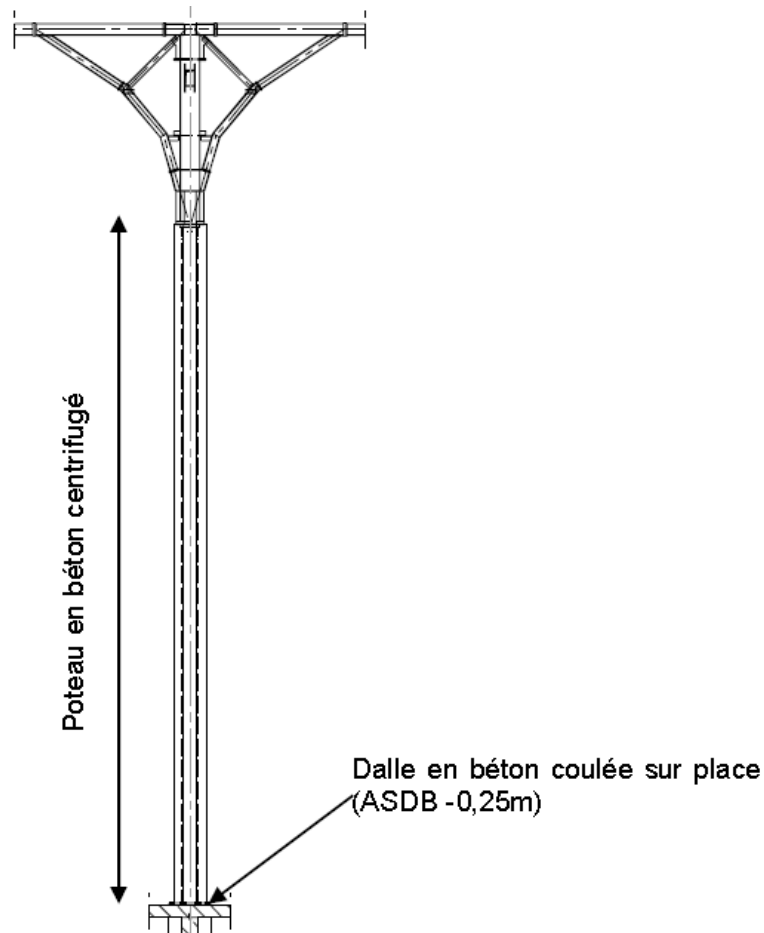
Structure d'un poteau de diamètre 81cm – Type n° 3
